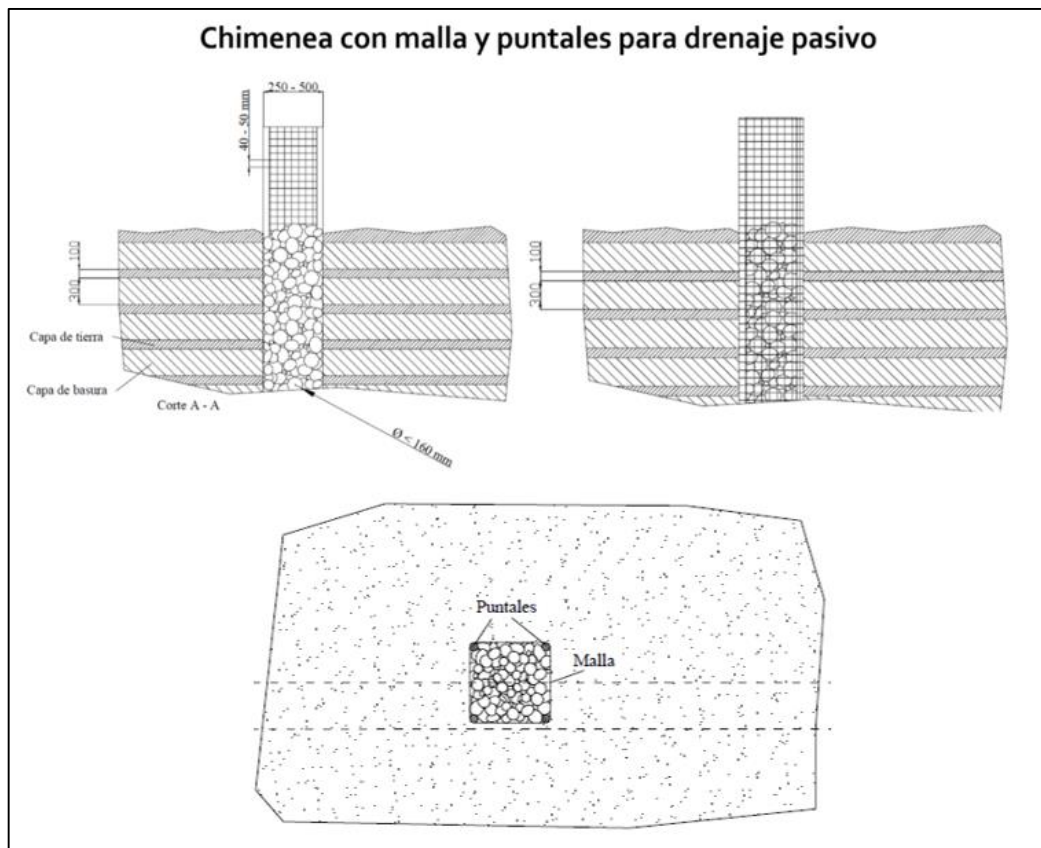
CHIMENEAS CON MALLA Y PUNTALES PARA DRENAJE PASIVO
